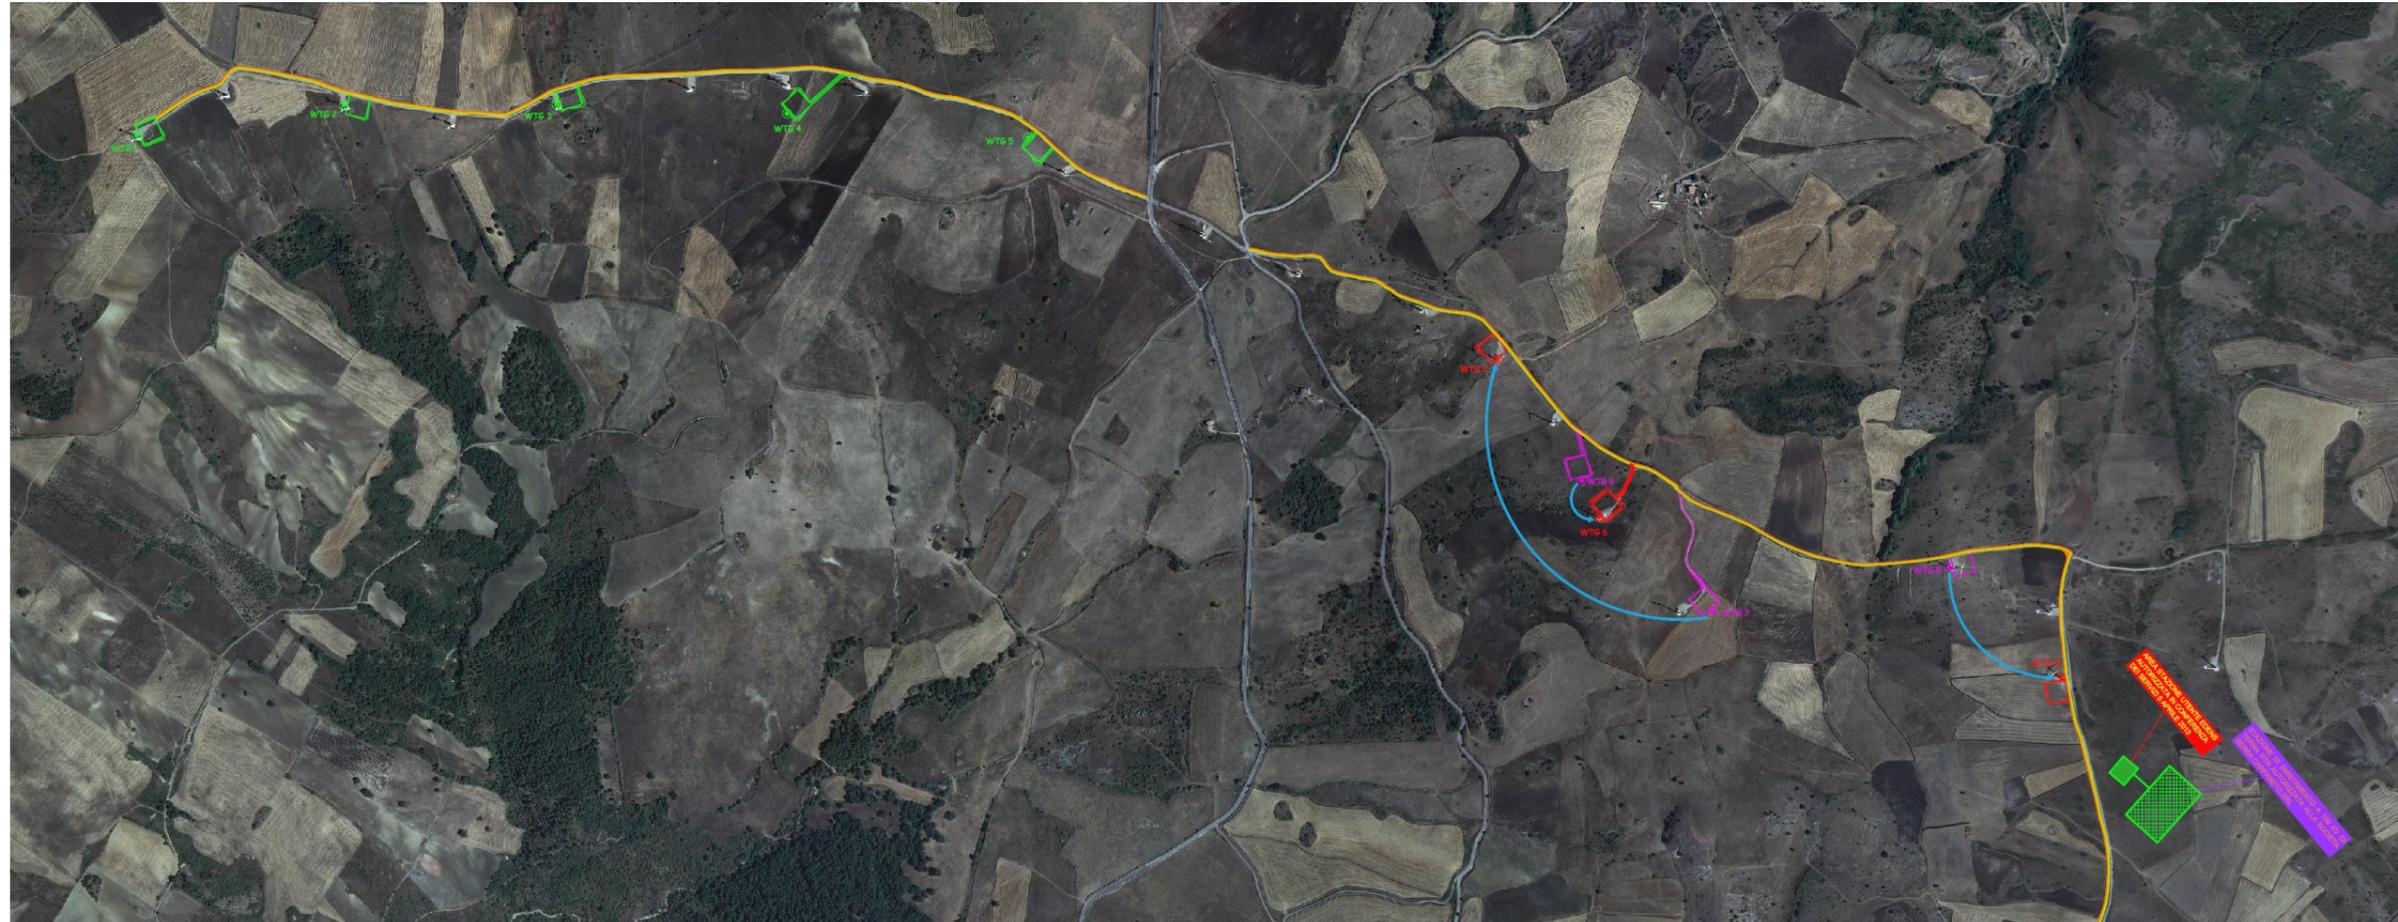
Planimetria su ortofoto con indicazione delle modifiche apportate al layout.
